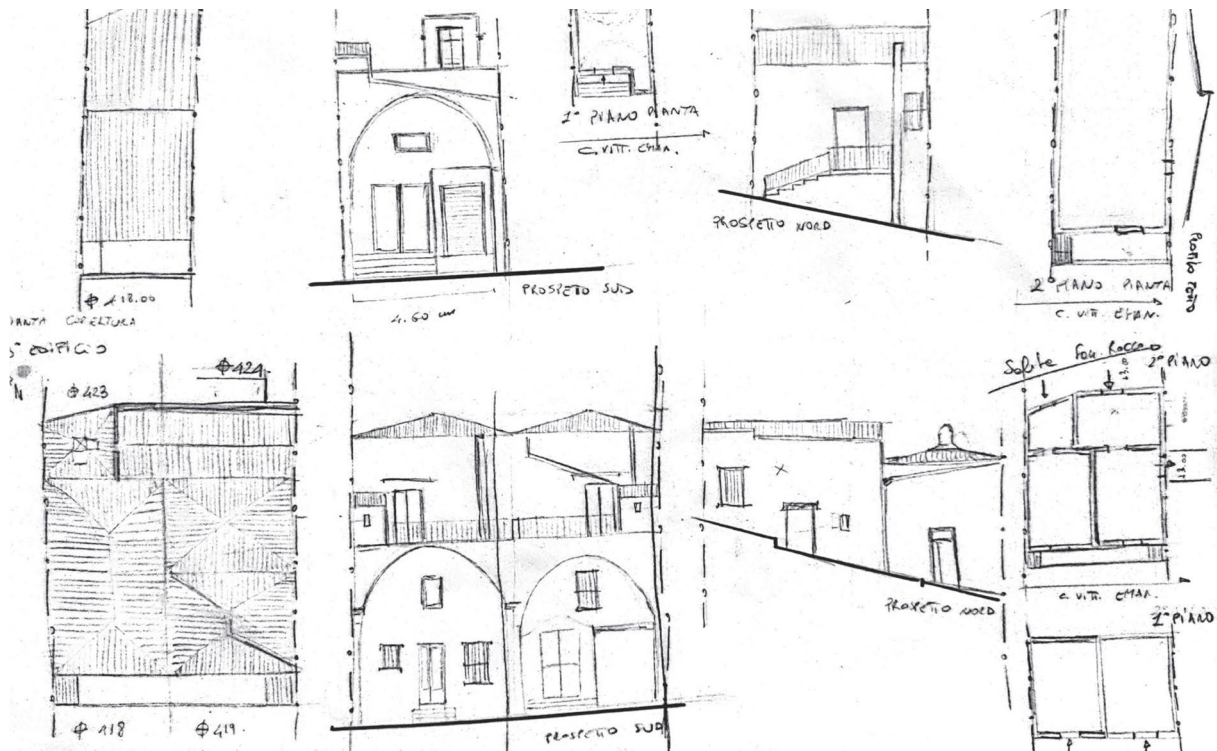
Croquis arquitectónico de levantamiento arquitectónico.
